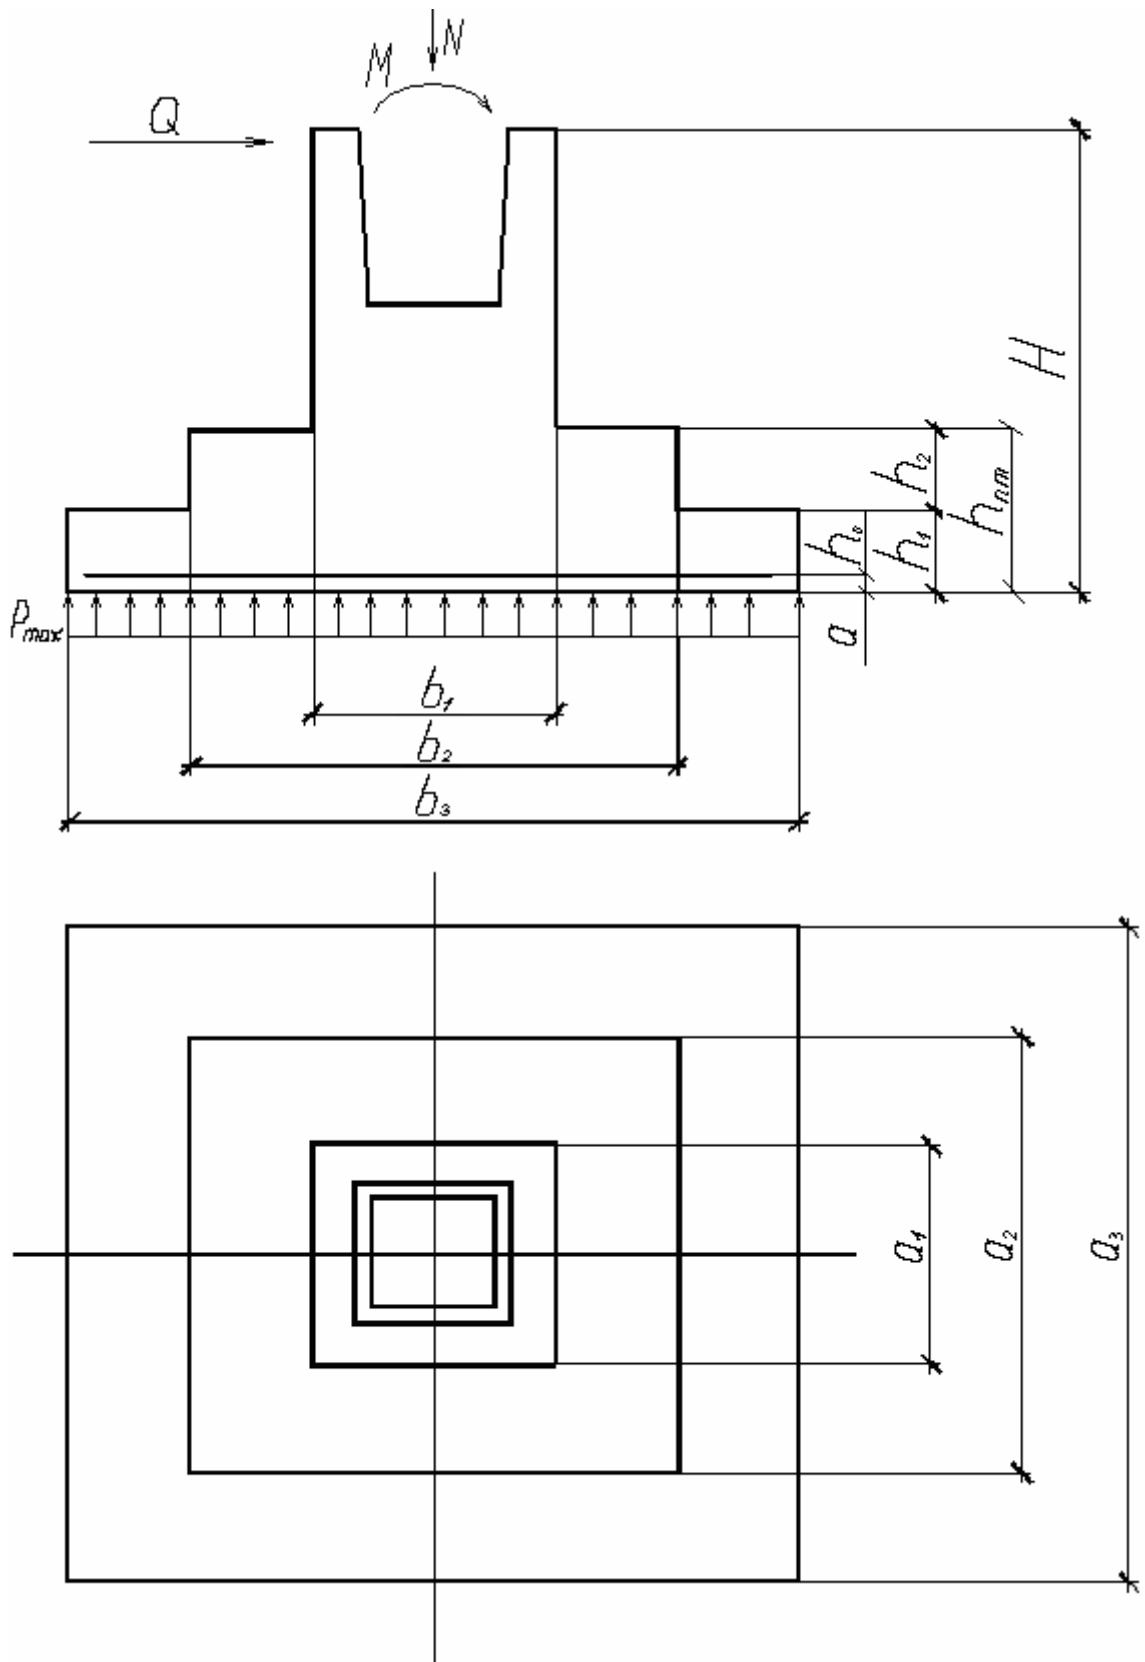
Схема рассматриваемого фундамента и нагрузки действующие на него.
